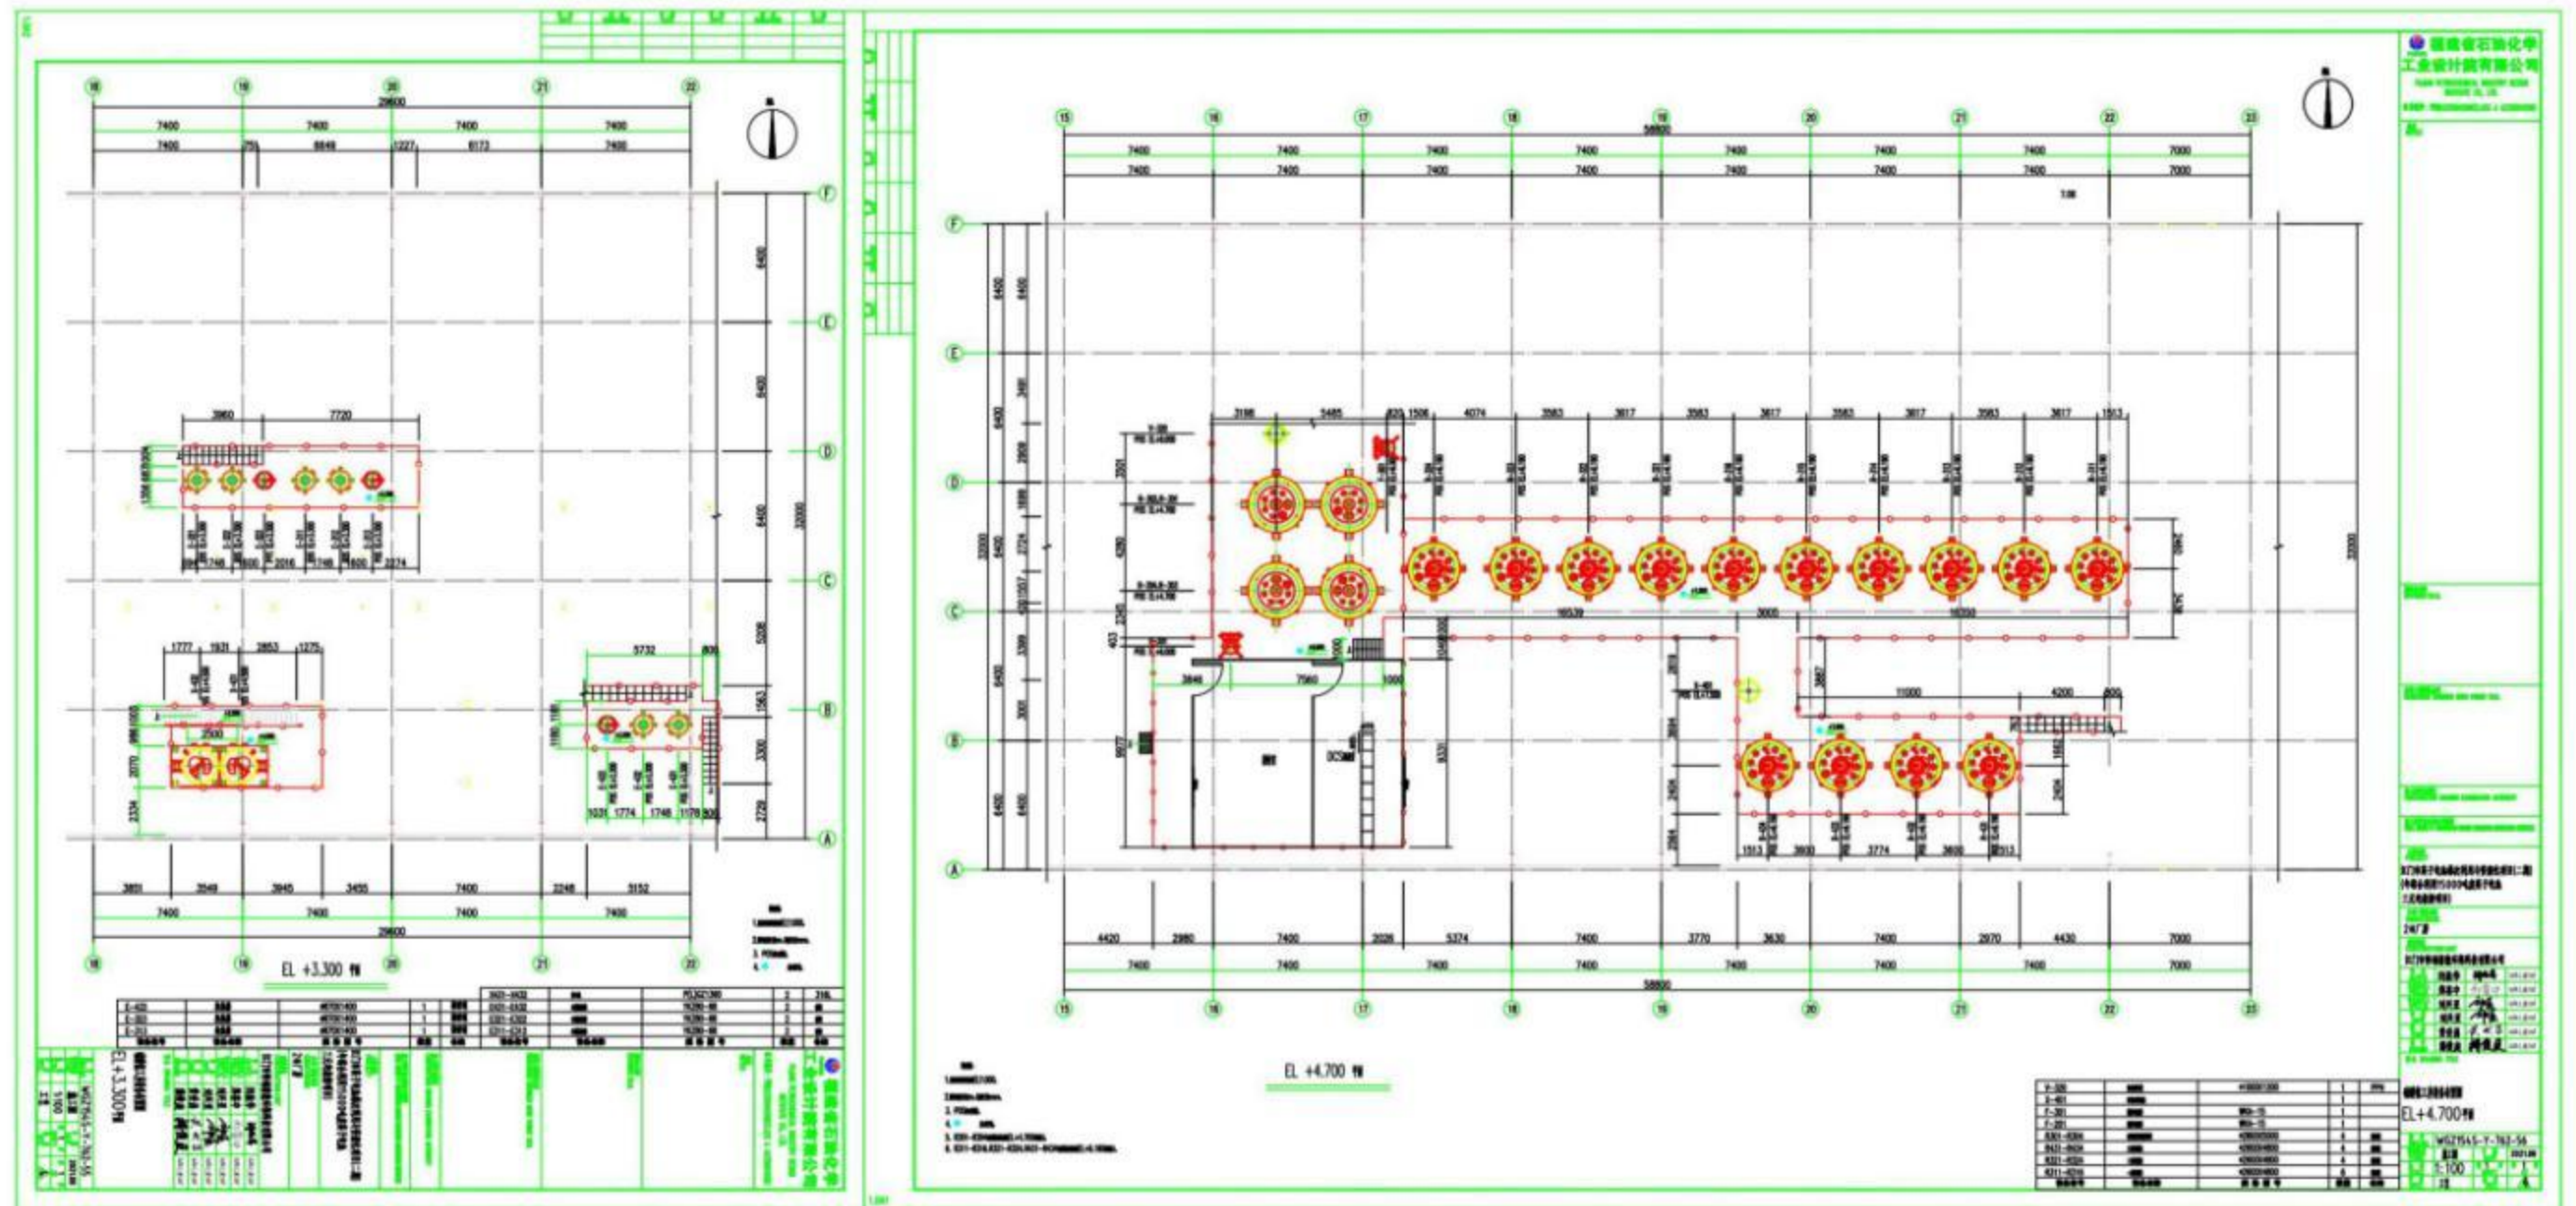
2#厂房-硫酸锰区域（3.00,4.70）平面布置图
